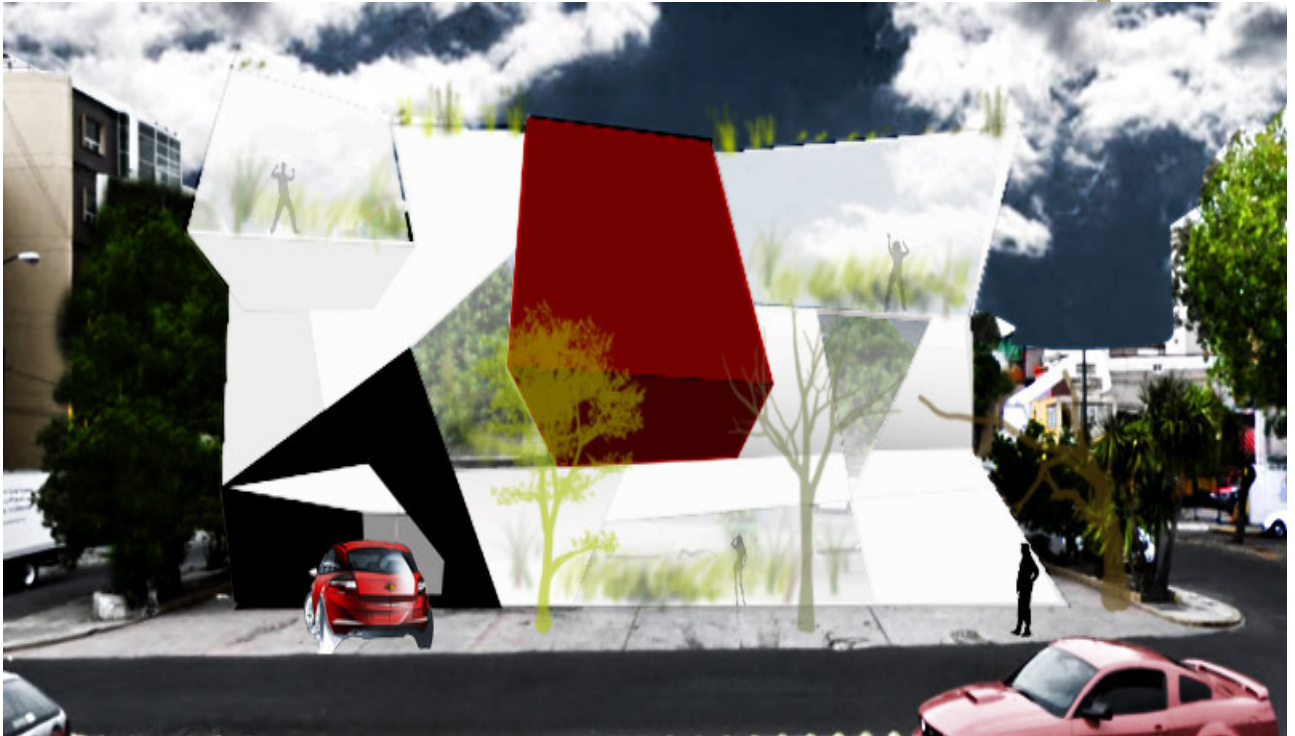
Proyección de fachada a Viaducto MA. del edificio 2, dibujo 3D autocad, Elaboración propia 2011
